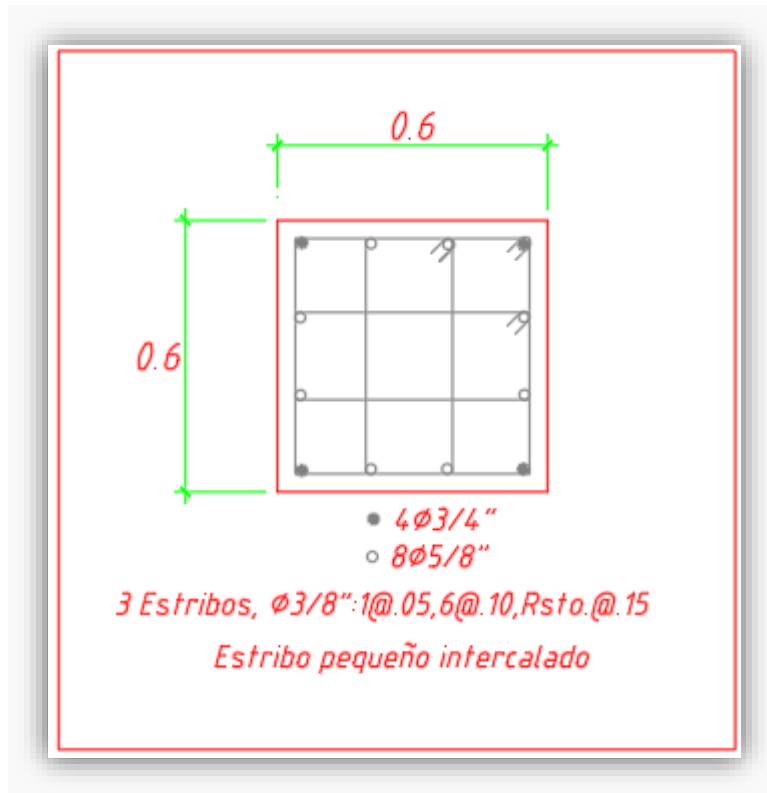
Detalle de refuerzo en columna C3 piso 4 y 5
